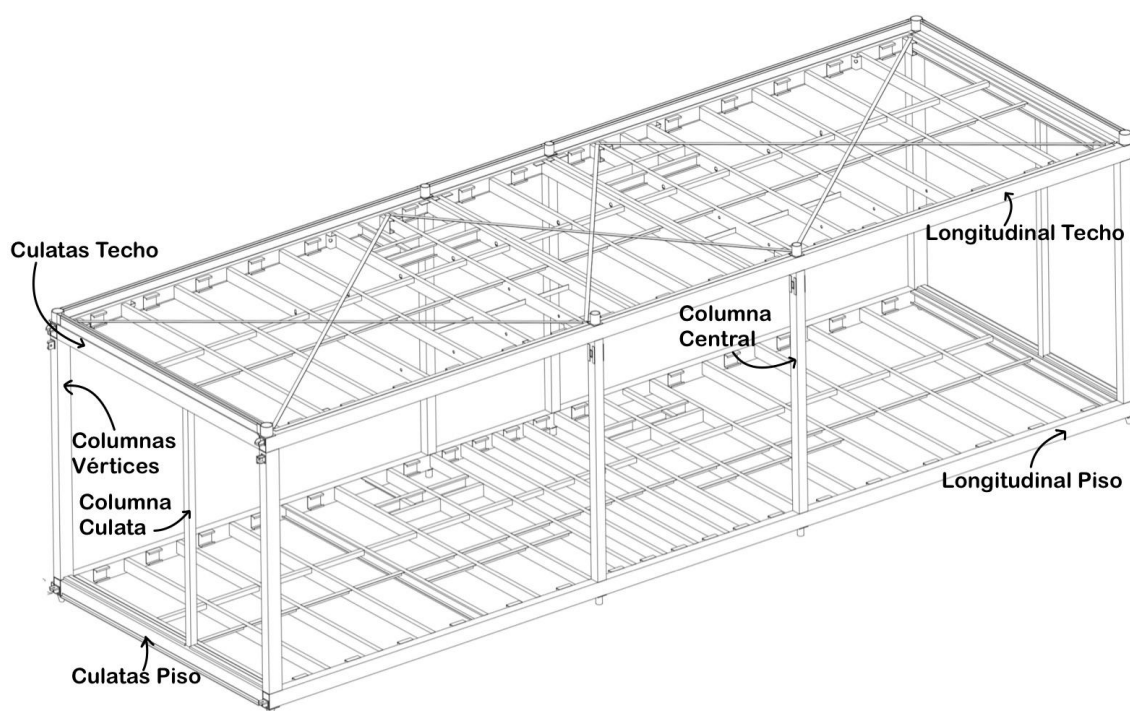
Estructura Metálica Proyecto 1331. Fuente: Promet
